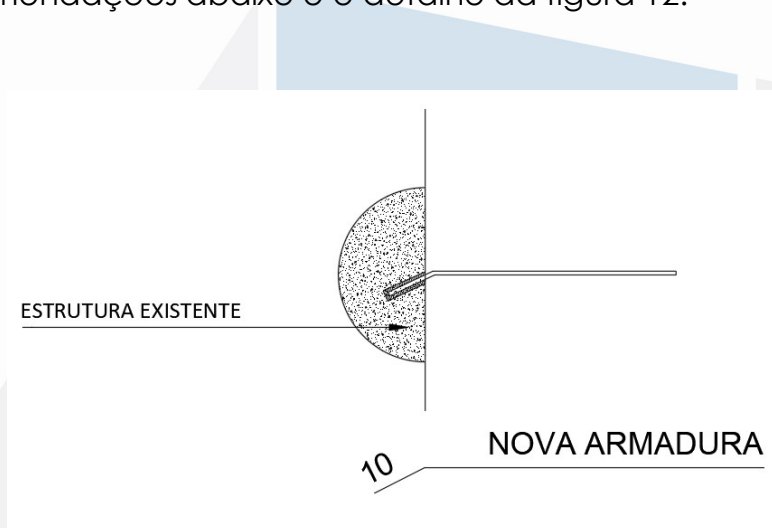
Detalhe em corte da PAR.01A – armadura transversal
